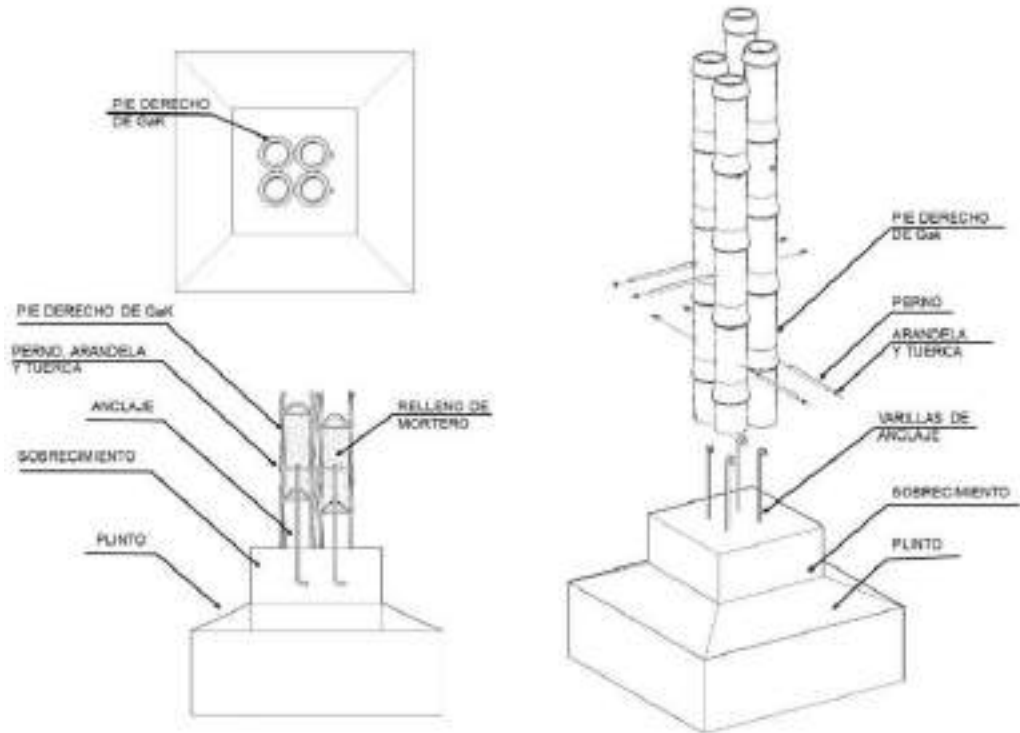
Detalle de cimiento y sobrecimiento para estructura de bambú.
